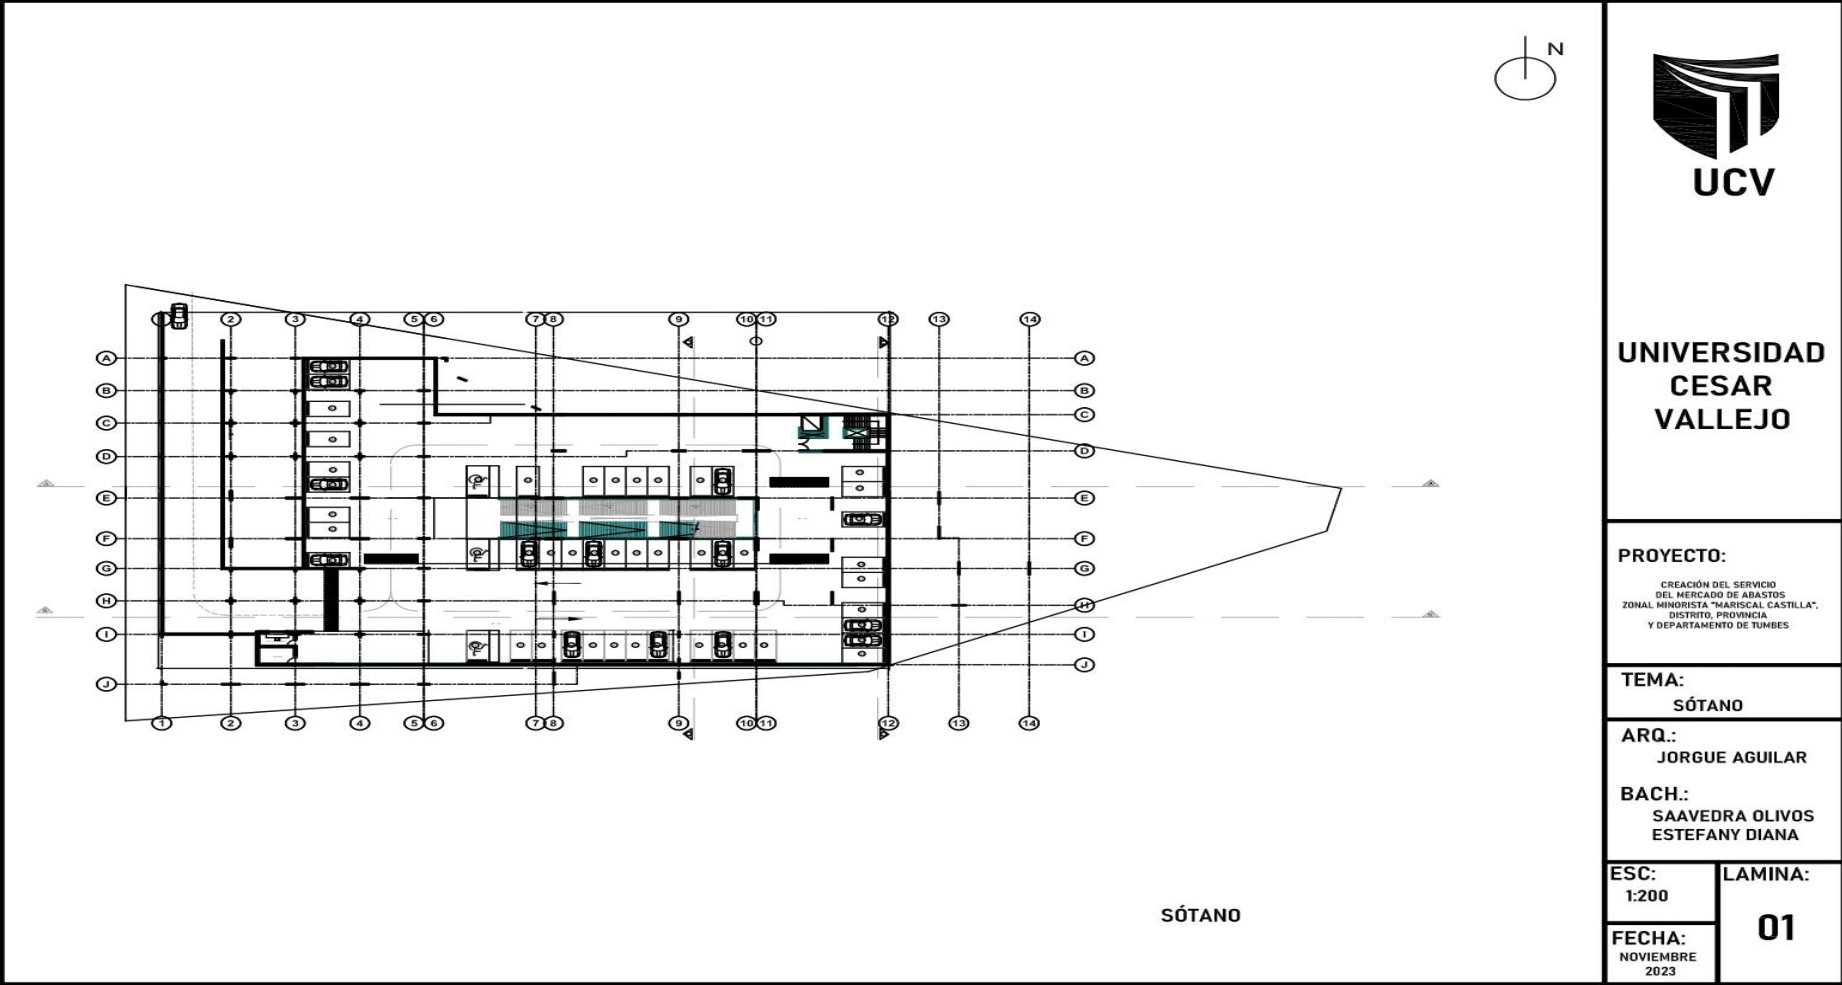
Plano general - Sótano. Fuente: Elaboración propia.
